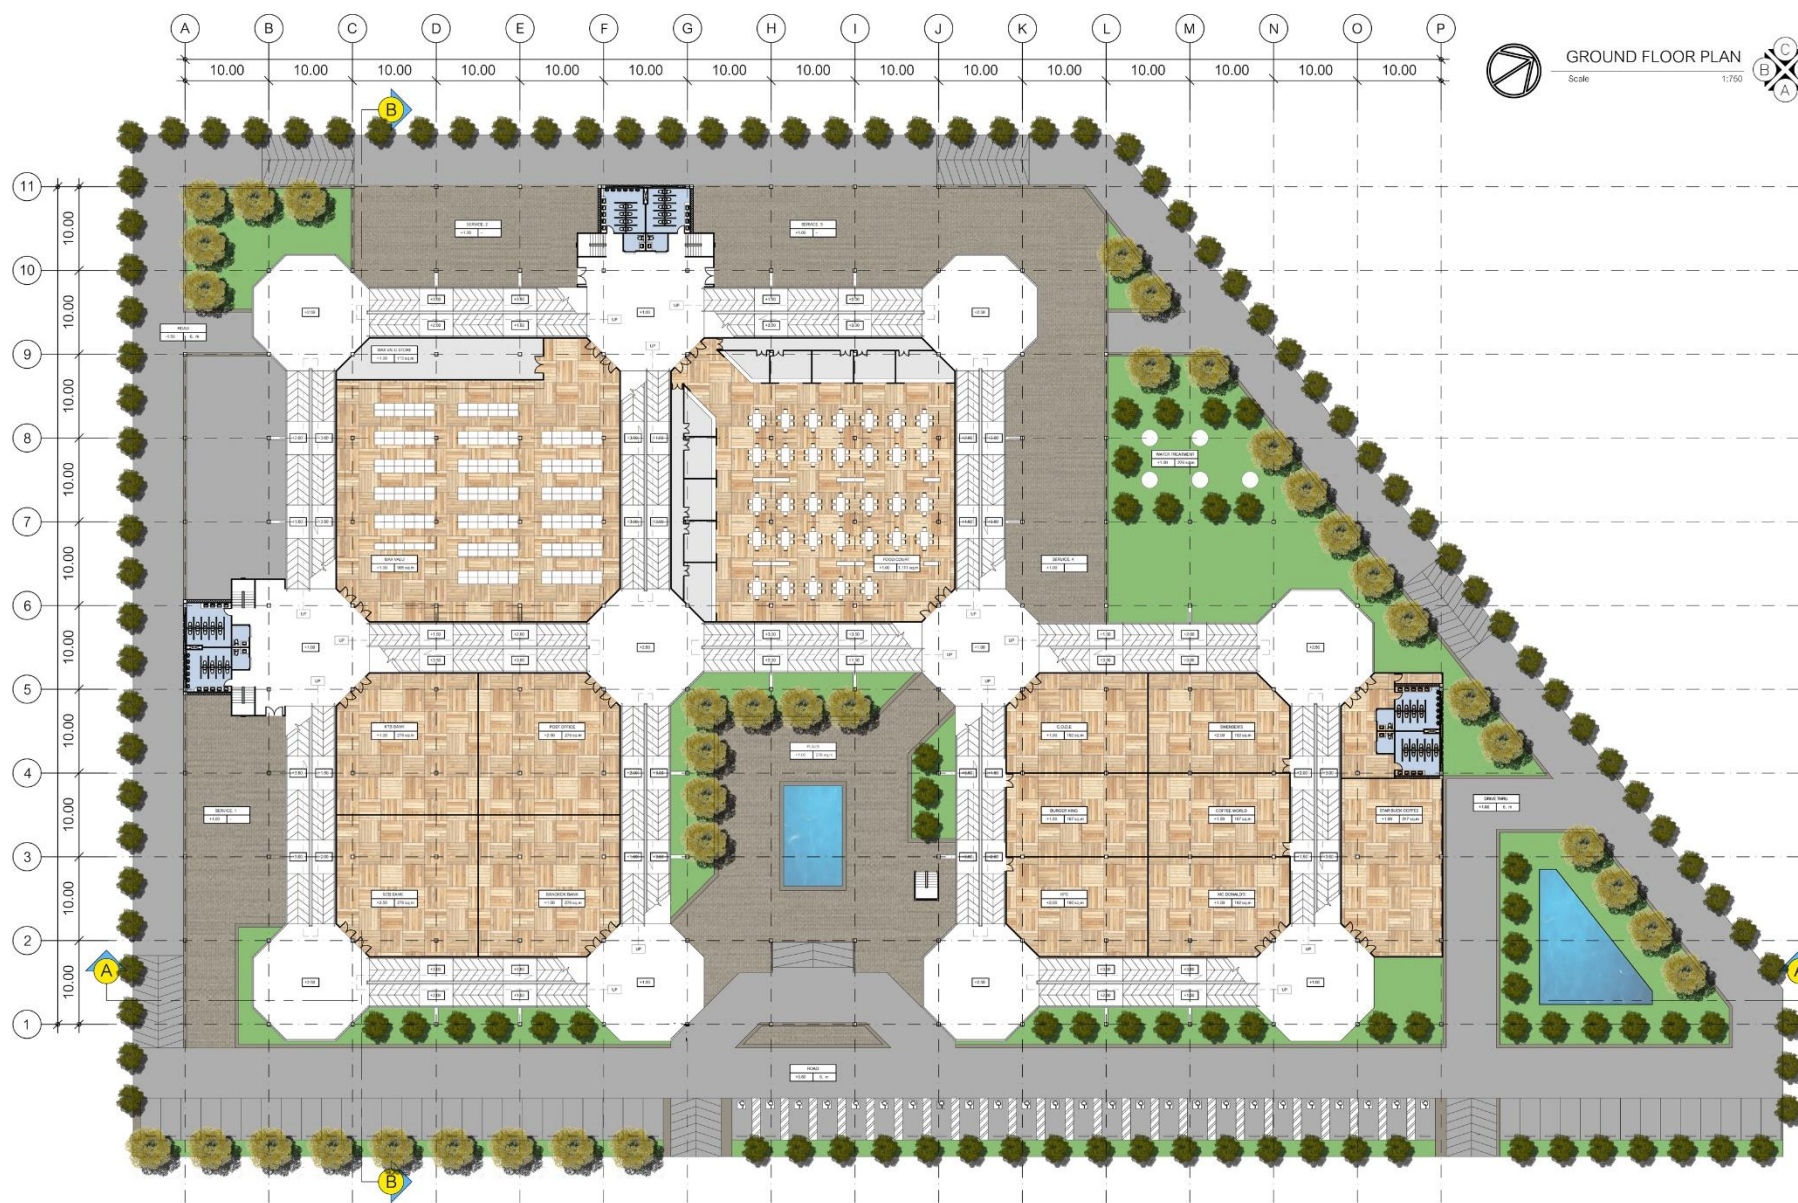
Site plan (การเข้าถึงโครงการ)
